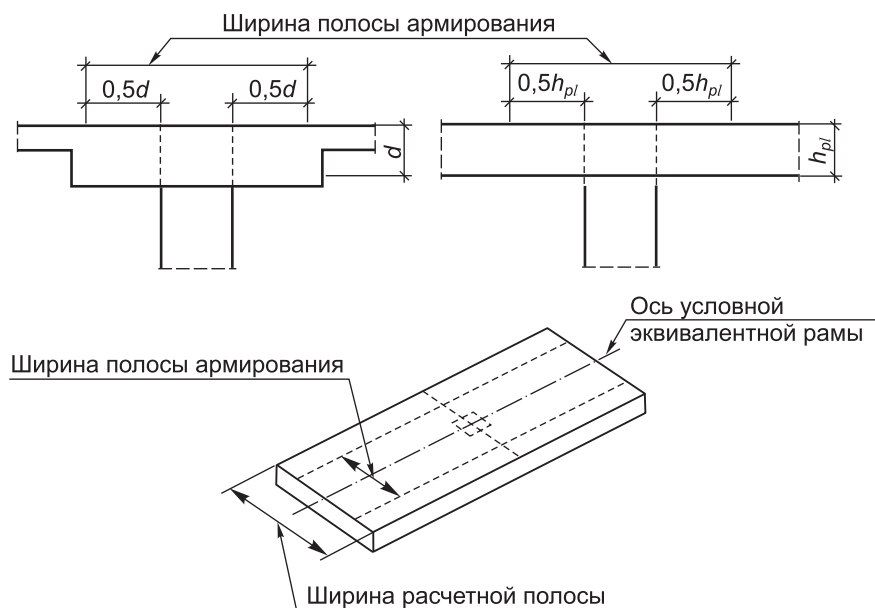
Схемы размещения ненапрягаемой арматуры, имеющей сцепление с бетоном
